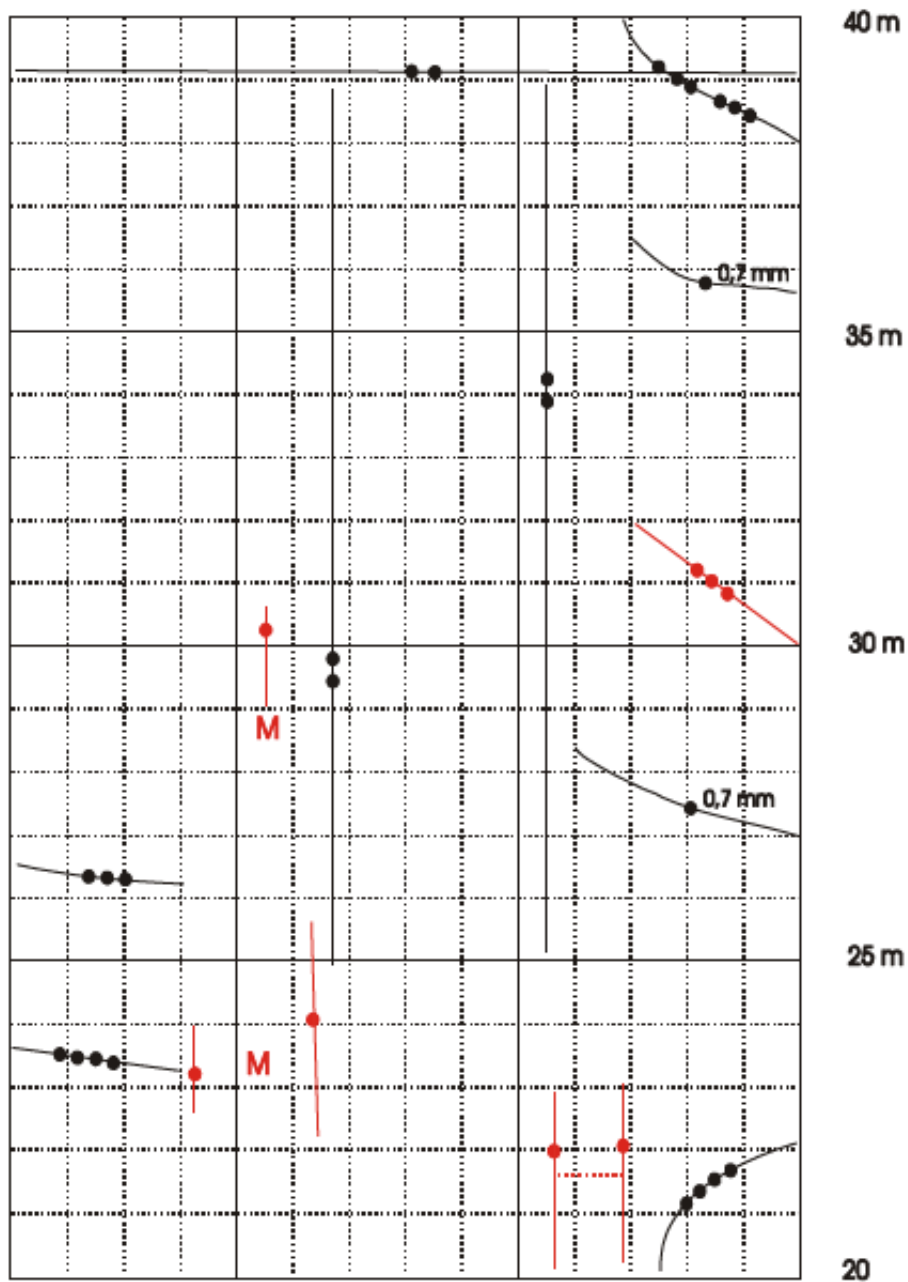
Planche de fissuration travée Nord-Ouest Zone 2
